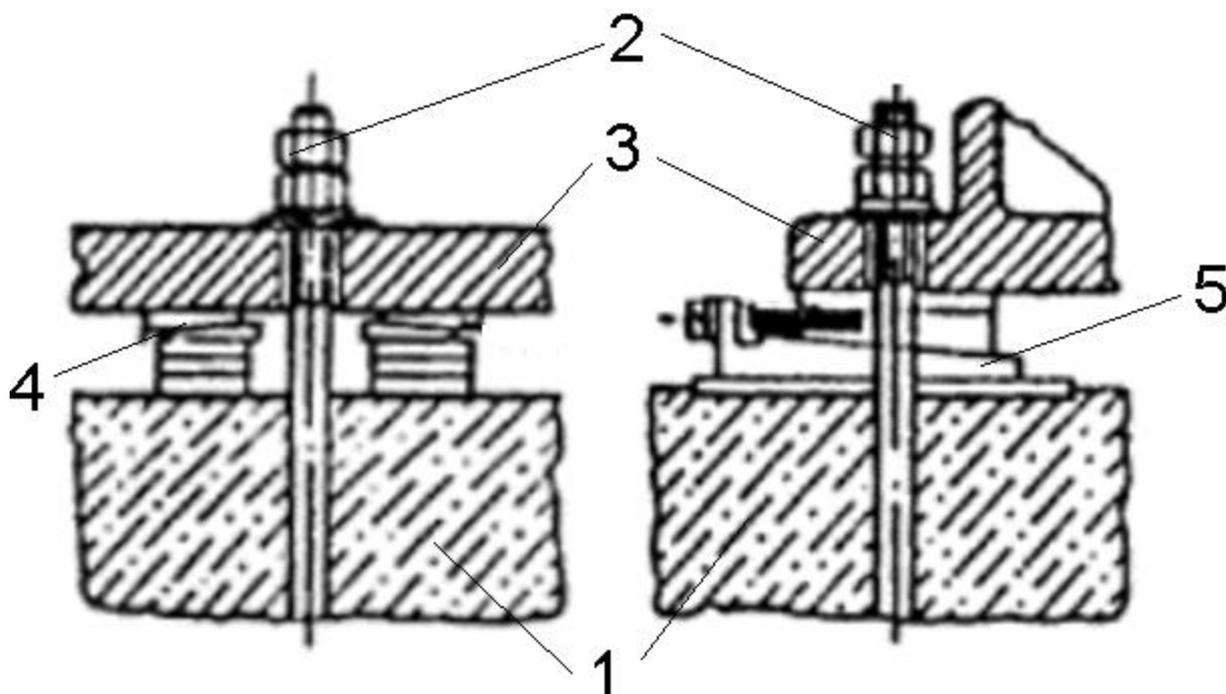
Выверка с помощью клиньев и опорных башмаков: 1 - фундамент, 2 - анкерный болт, 3 - монтируемое оборудование, 4 - клинья, 5 - опорный башмак.
